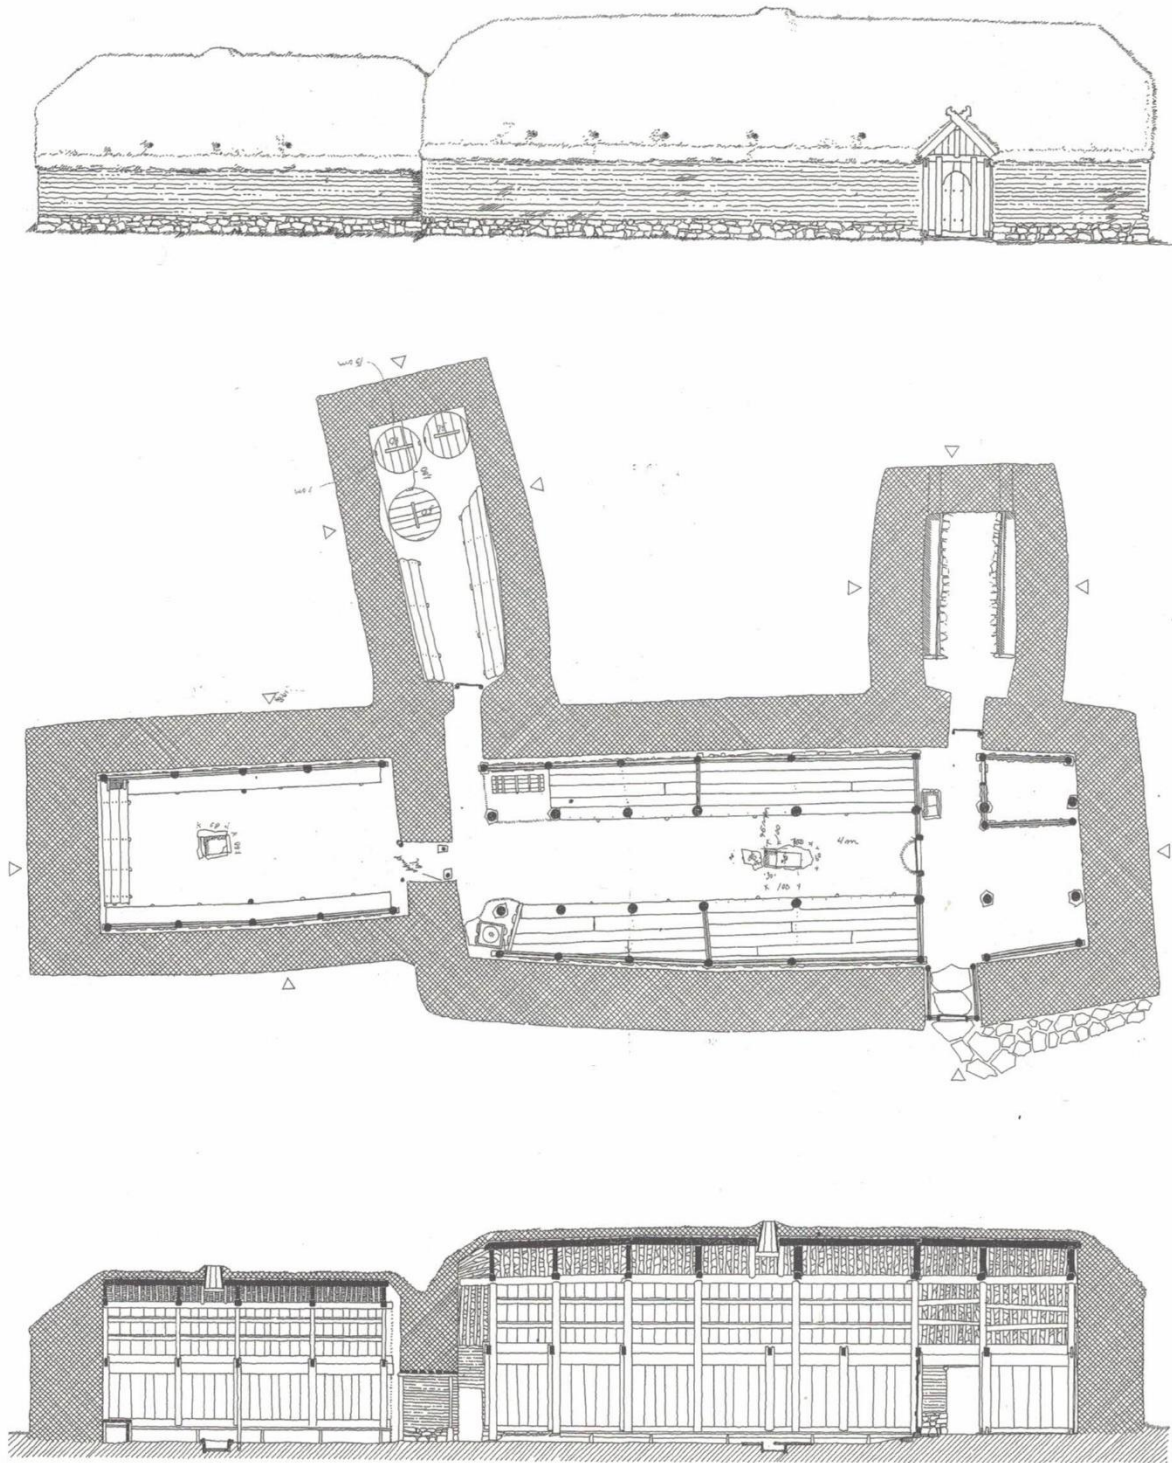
élévation, plan et coupe de la maison hypothétique de Stöng par Hörður Ágústsson.
